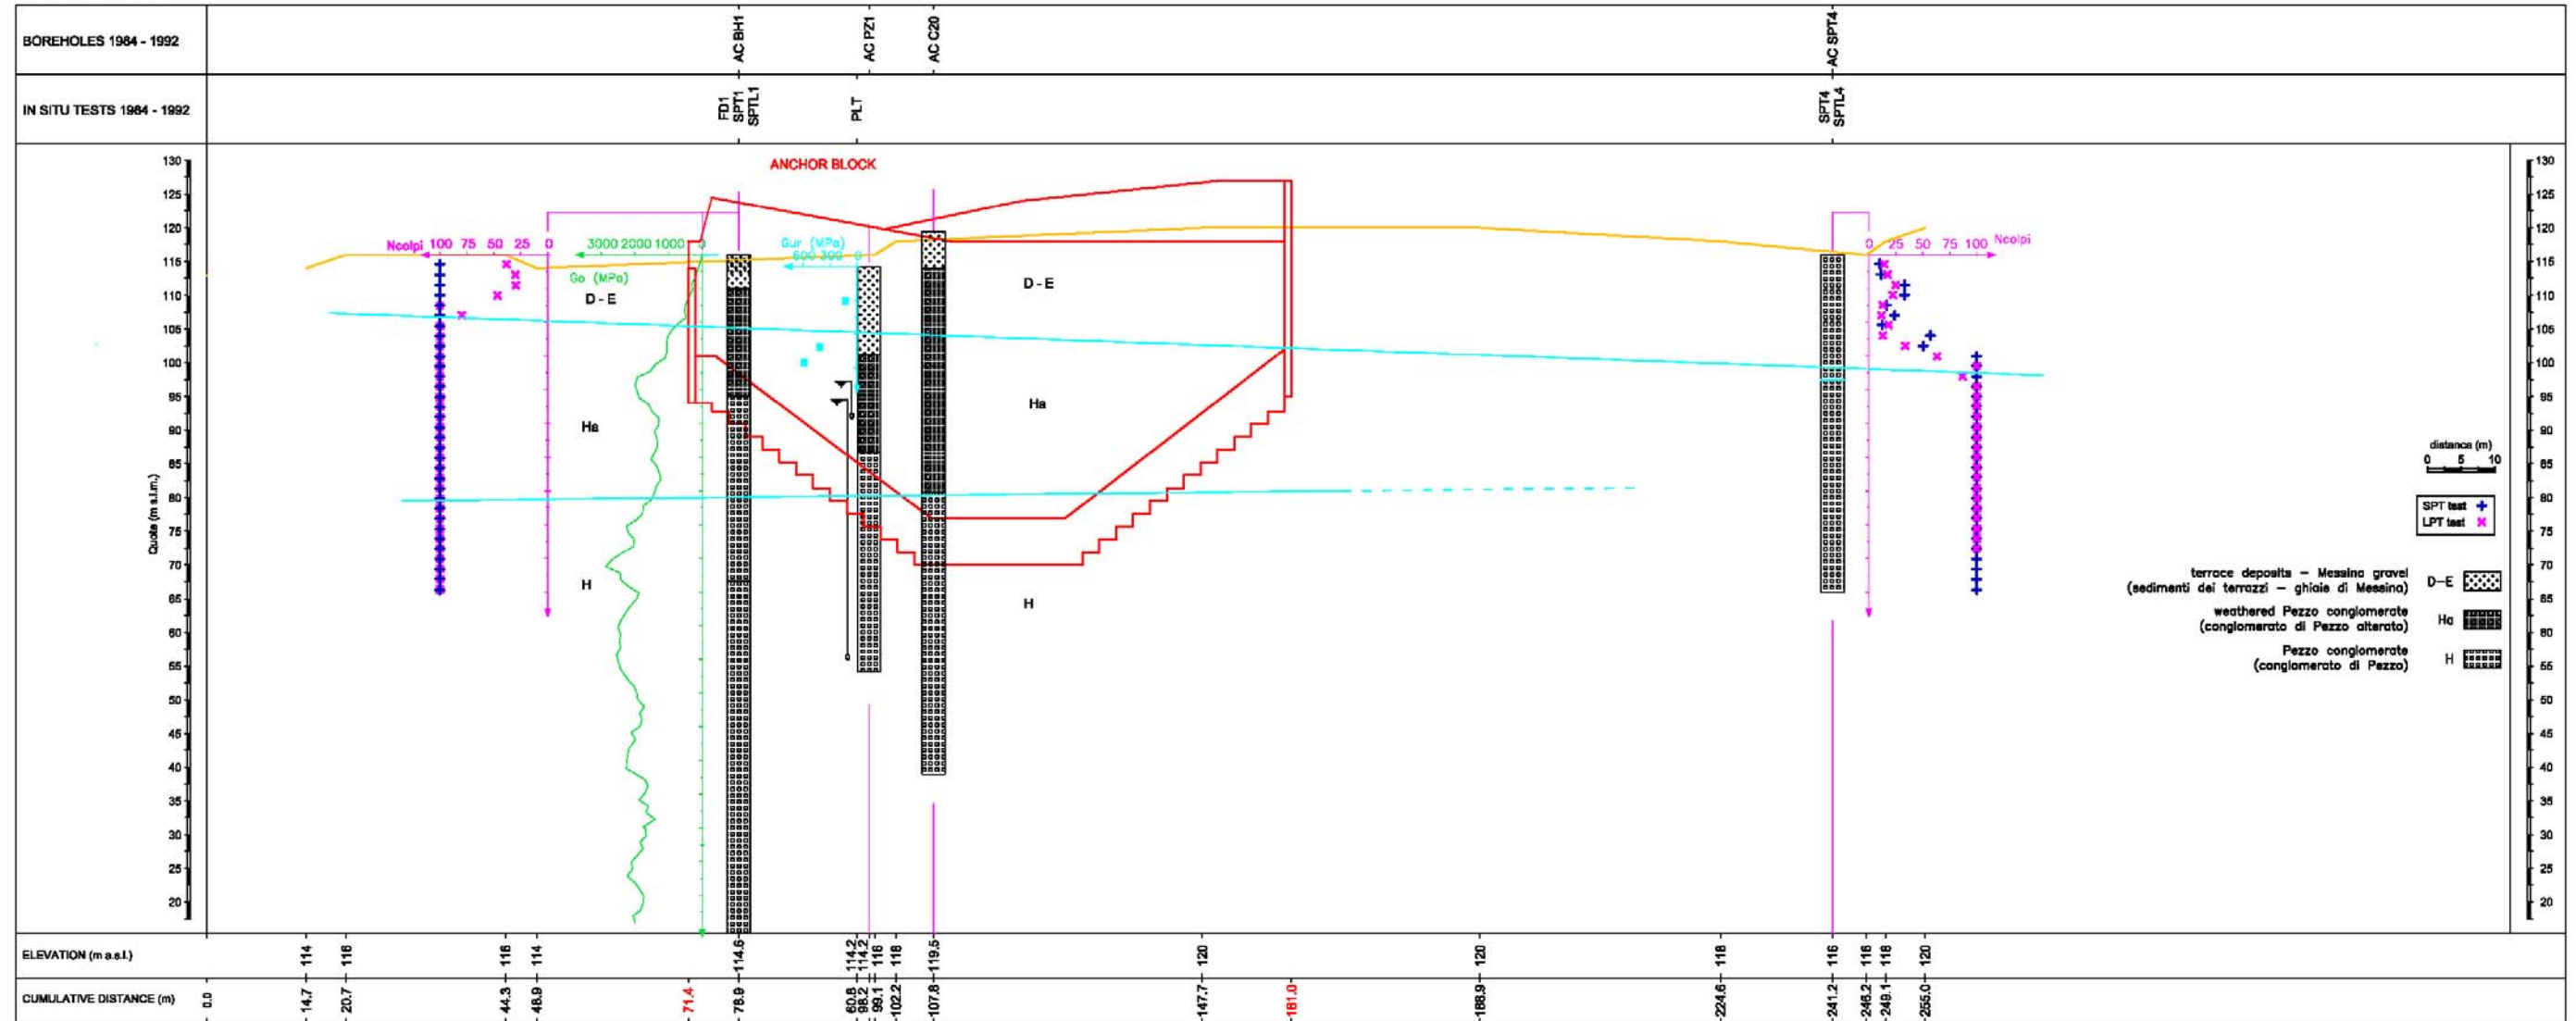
Blocco di Ancoraggio Calabria, sezione trasversale N. 1
